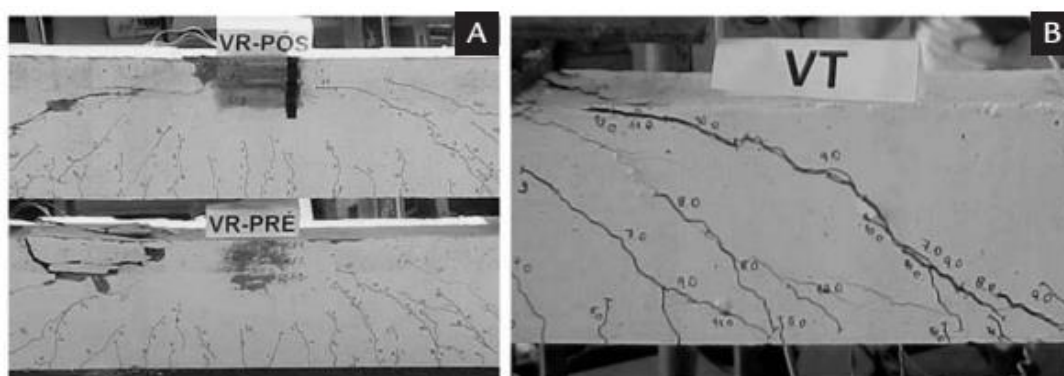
Fissuração das vigas ensaiadas (ANDO *et al.*, 2012).
